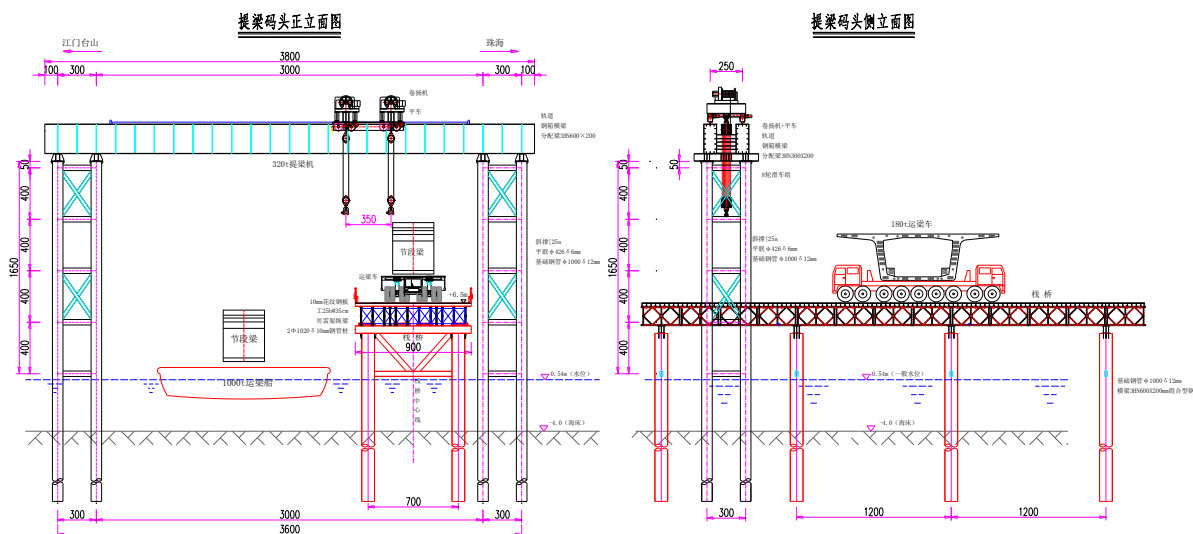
提梁码头立面图 (单位尺寸: cm)
